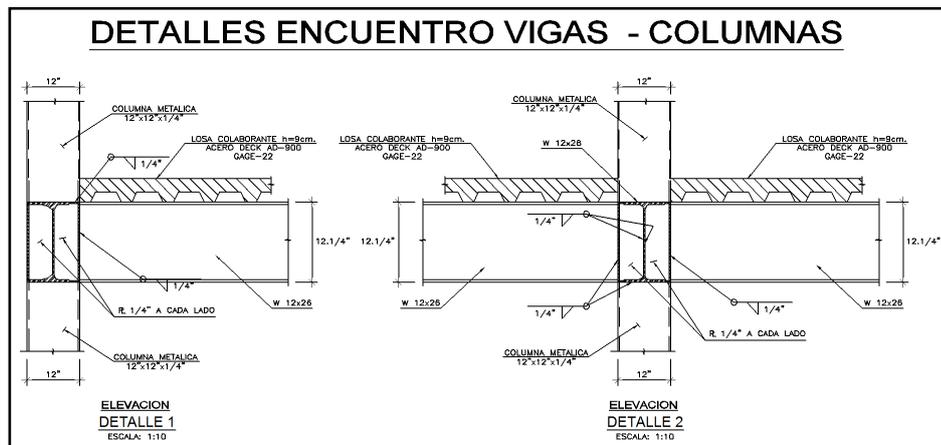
Detalle encuentro de vigas. FUENTE: Elaboración Propia
